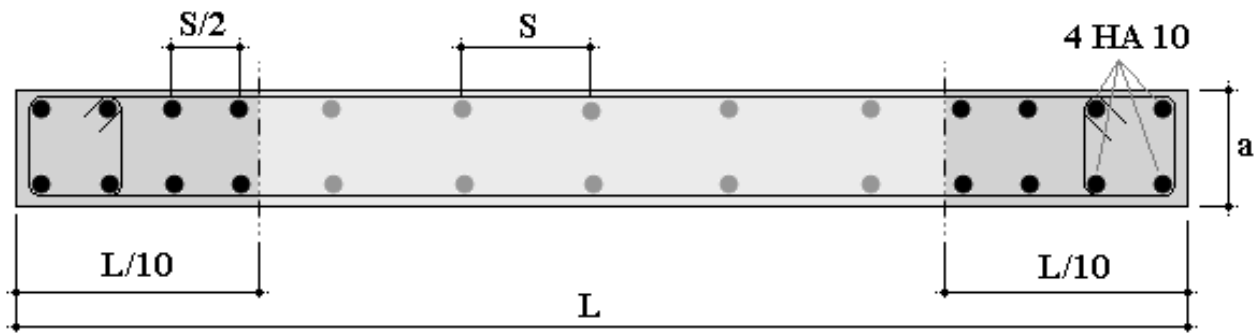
Disposition des armatures verticales dans les voiles.
